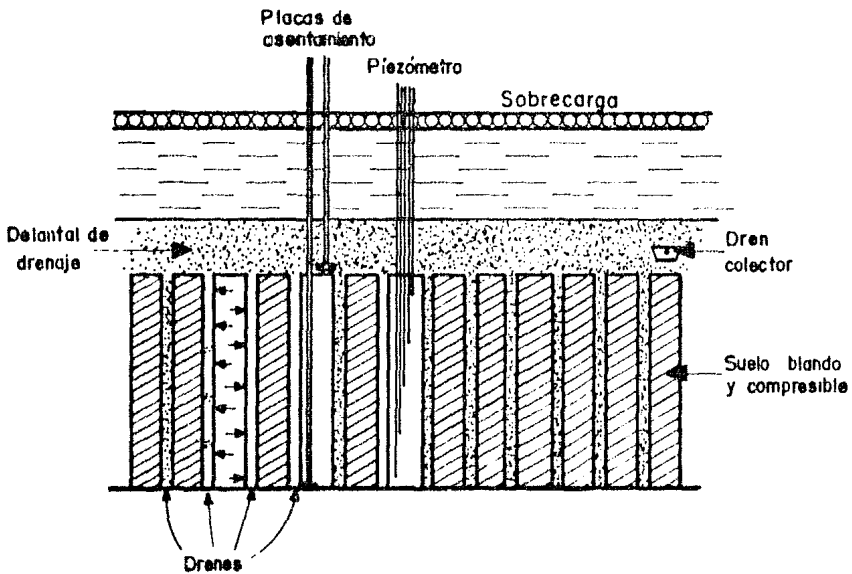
PERFIL DE UNA ZONA TRATADA CON DRENES
